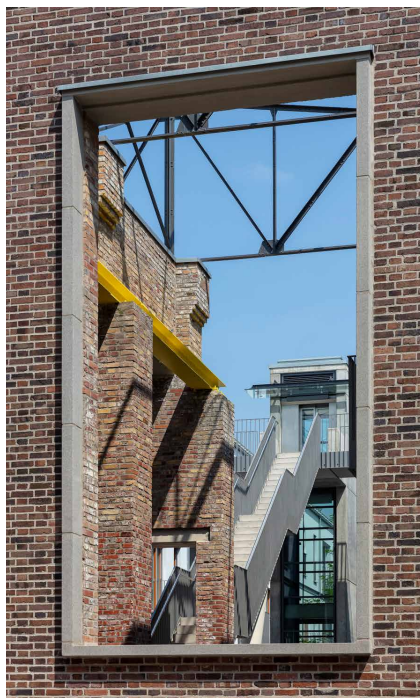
Fassadenausschnitt des sanierten Südgiebels mit Blick in die Halle 17
